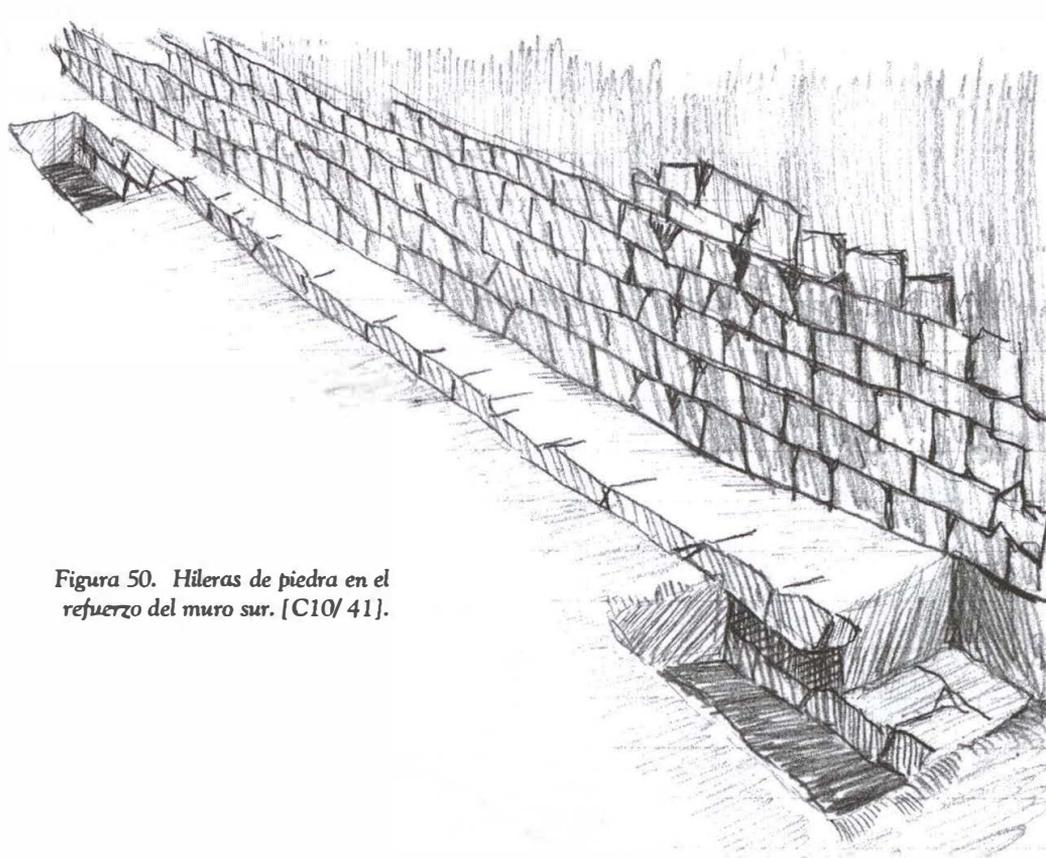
Hileras de piedra en el refuerzo del muro sur. [C10/ 41].
